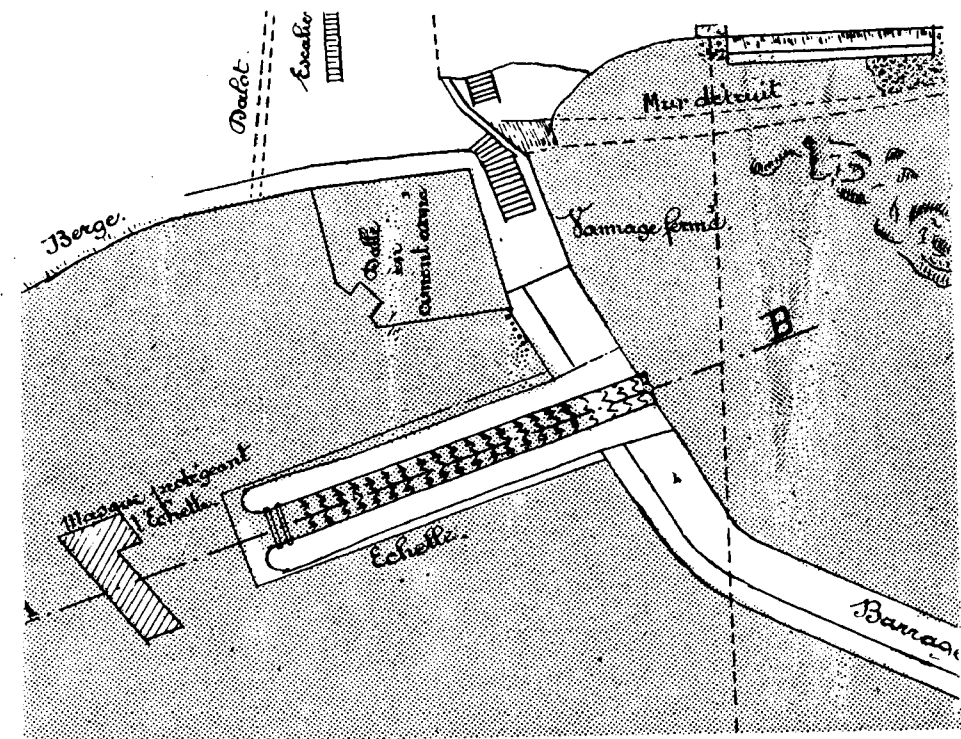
Plan du barrage Bedat, avec l'échelle installée dans le bief amont.
